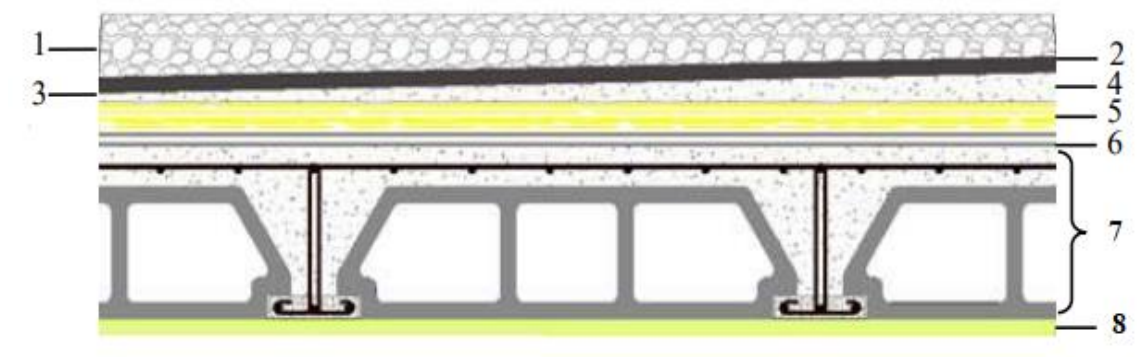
Composants d'un plancher terrasse en corps creux.
